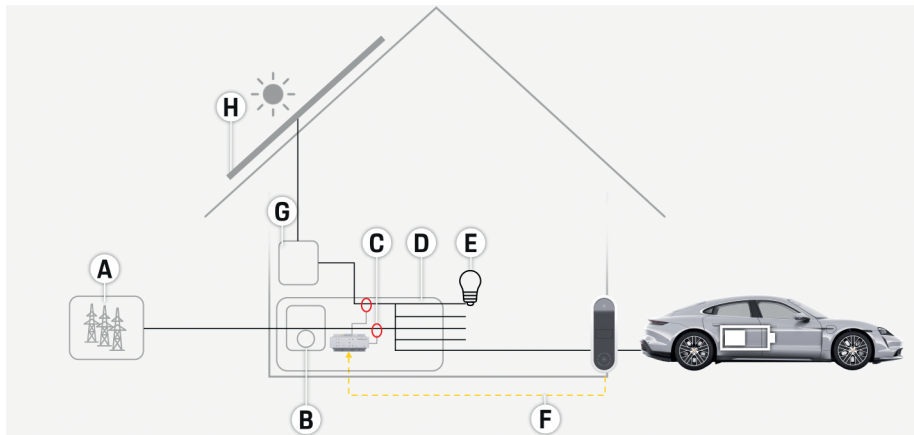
Exemple d'installation : installation domestique simple avec installation photovoltaïque
